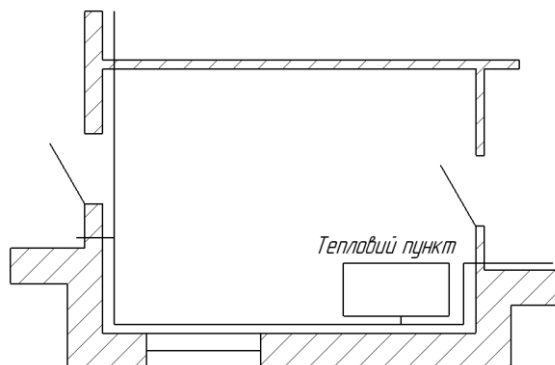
План приміщення будинку із зображенням теплового пункту та магістральних трубопроводів у кімнаті № 8 (рис. 1.2).
